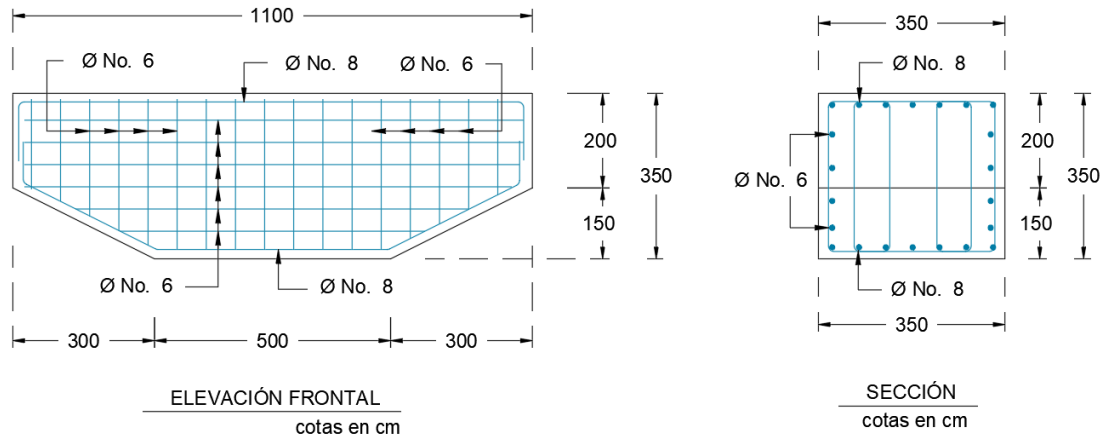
Geometría y refuerzo del cabezal de las Pilas. Fuente: Elaboración propia
